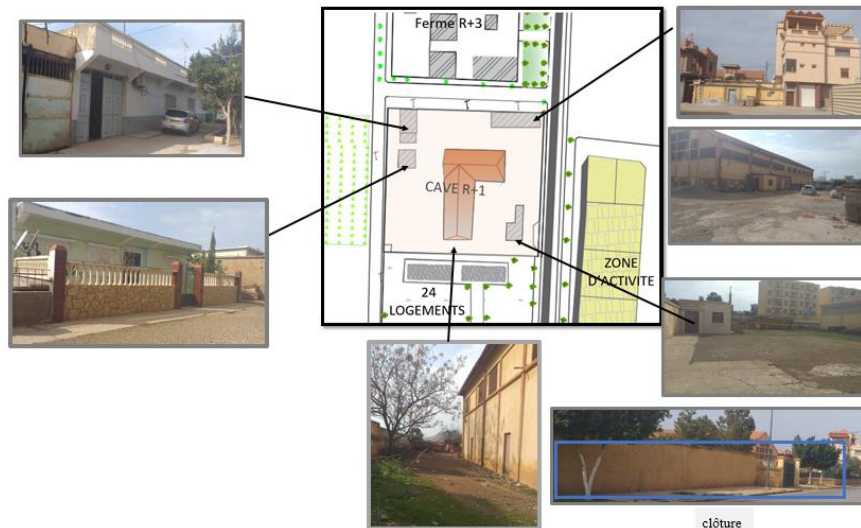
Structures existantes sur le site d'intervention.⁶²
